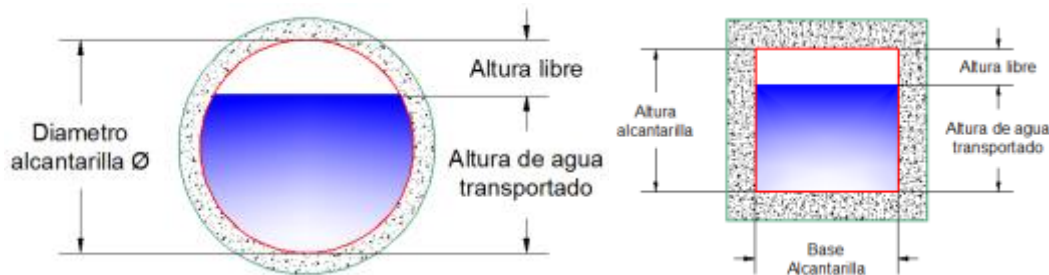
Detalle esquemático de alcantarillas nuevas
